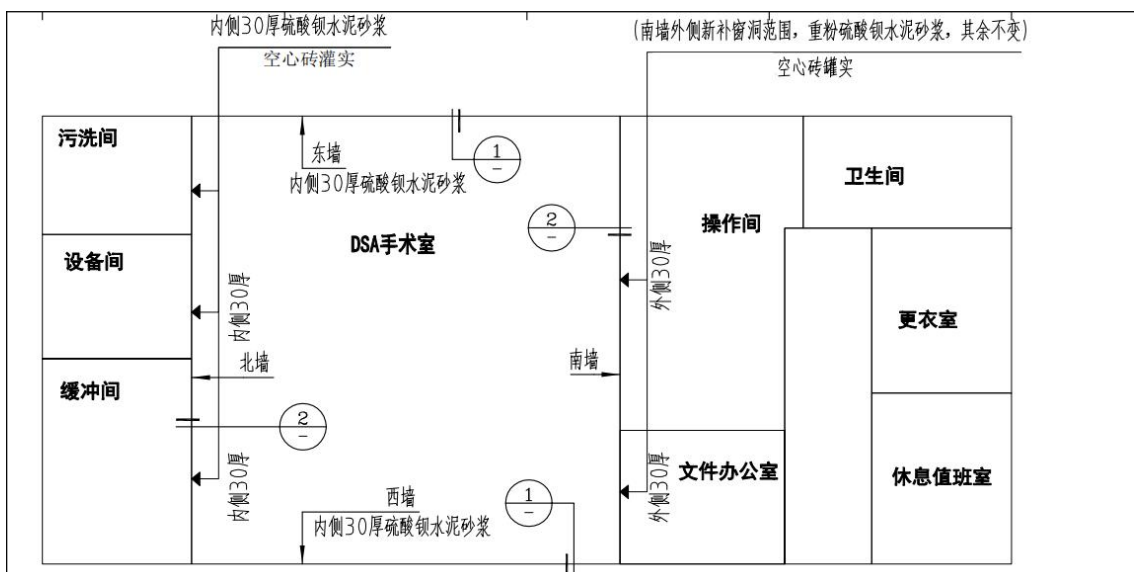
DSA 手术室墙体屏蔽改造平面布置图
